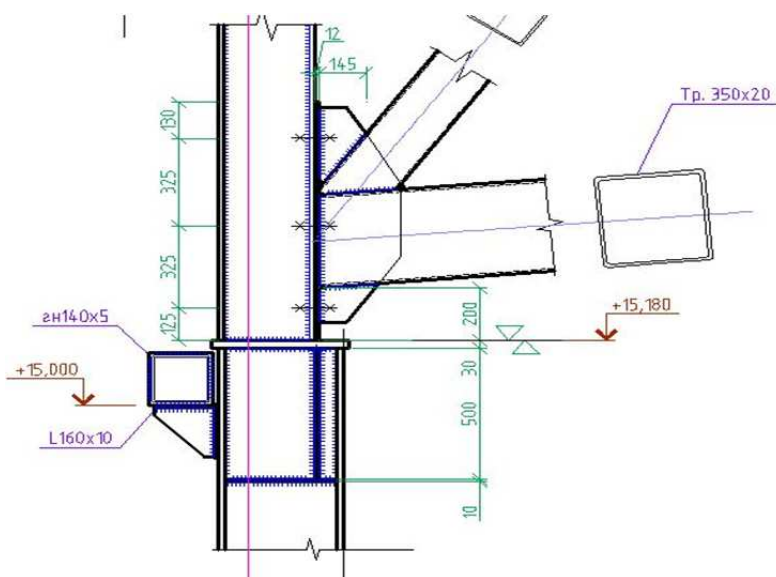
Нижний опорный узел сопряжения фермы
